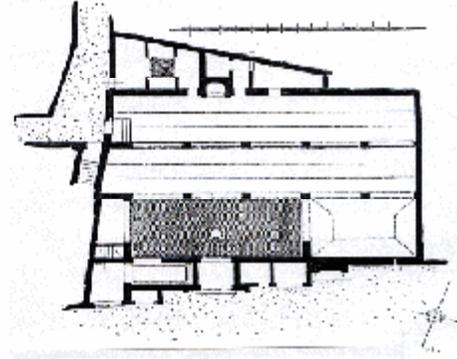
مسقط أفقي لمسجد ابن الحسن بفاس القديمة
